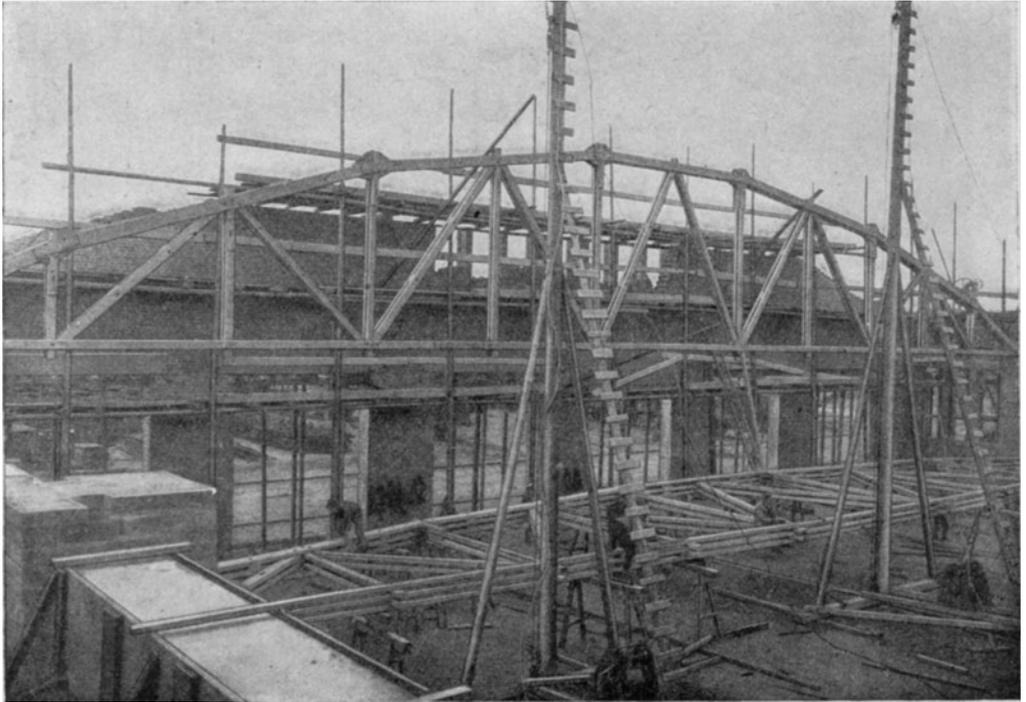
Montagehalle mit Fachwerksbindern System „Freibau in Holz“, Stützweite 39,5 m, mit zentrischem Stabanschluß.
